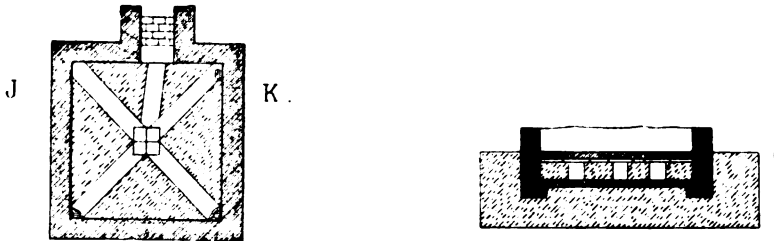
Grundriß und Schnitt einer Kanalheizung. Römerkastell Saalburg.
